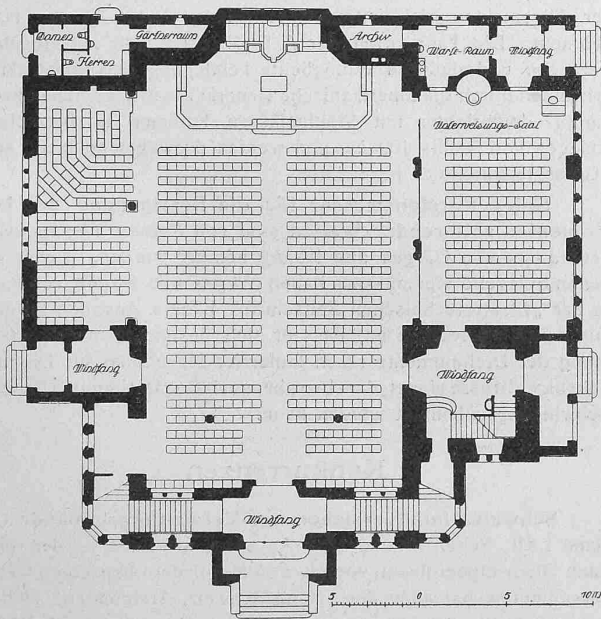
und 5. Grundrisse der evangelischen Kirche in Romanshorn. — Masstab 1:400.
